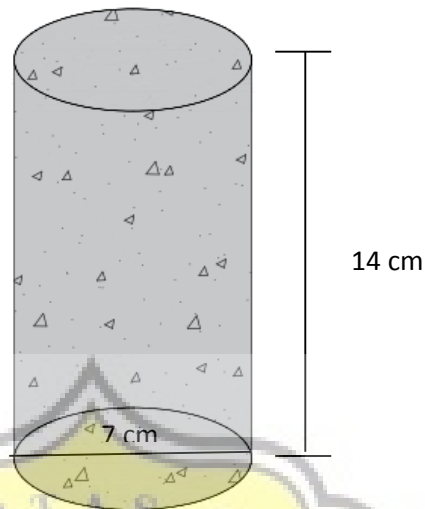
Pengambilan Inti Beton Kolom di Pucang Gading
